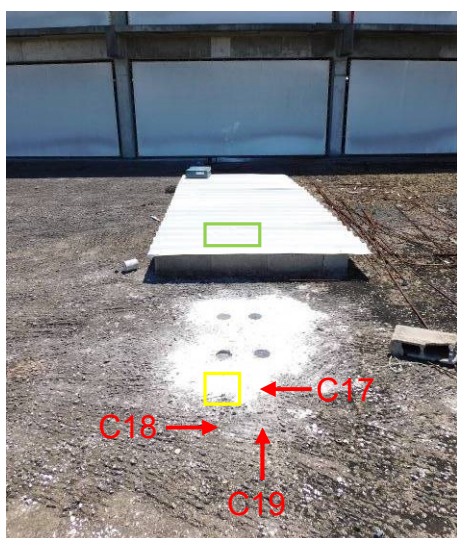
Idem. Piso 5. Zona Z(5).2, com deteção da malha de armaduras na face superior da laje, com recurso ao equipamento detetor de armaduras (pacómetro), para extração de três carotes (designadas de C17, C18 e C19) destinadas a ensaios laboratoriais (ensaios de compressão). Presença de orifício (assinalado a amarelo) em que a tentativa de extração de carote foi mal sucedida, devido ao comprimento insuficiente para ensaio laboratorial. Localização da zona da sondagem realizada para medição da profundidade de carbonatação (assinalada a verde).
